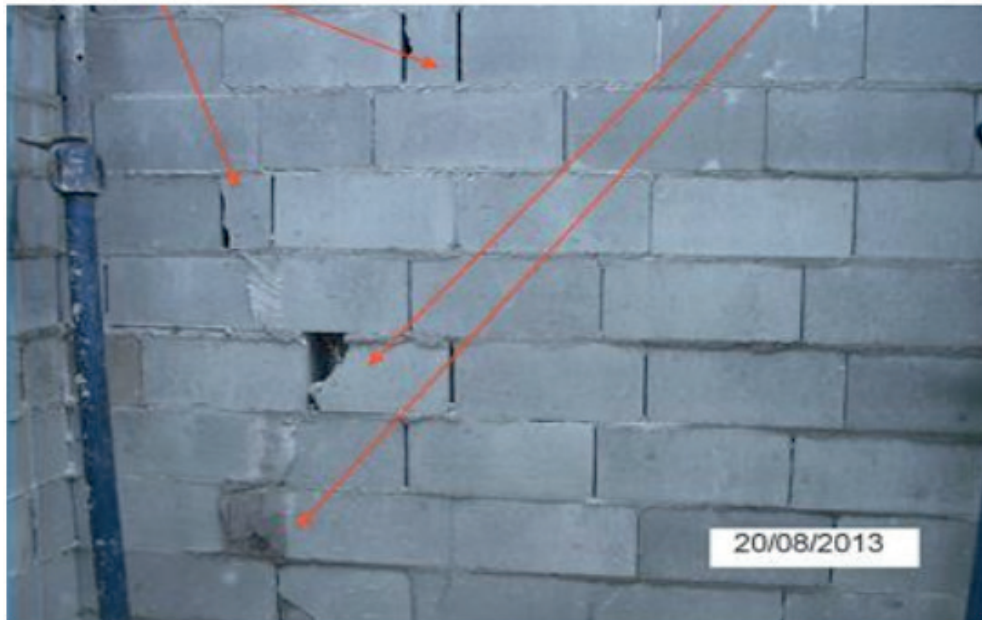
Bloco de concreto cortado e preenchido com argamassa.
